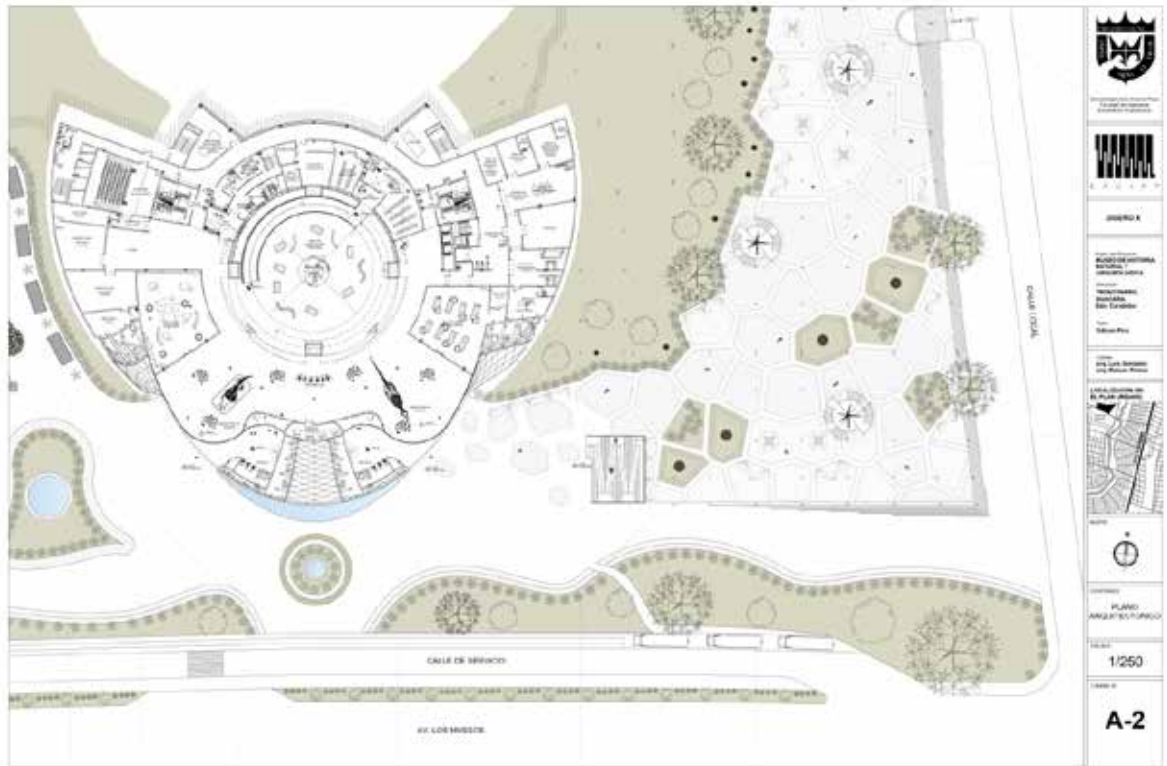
Planta Baja Nivel 0.00. Fuente: Presente Autor. (2021)
